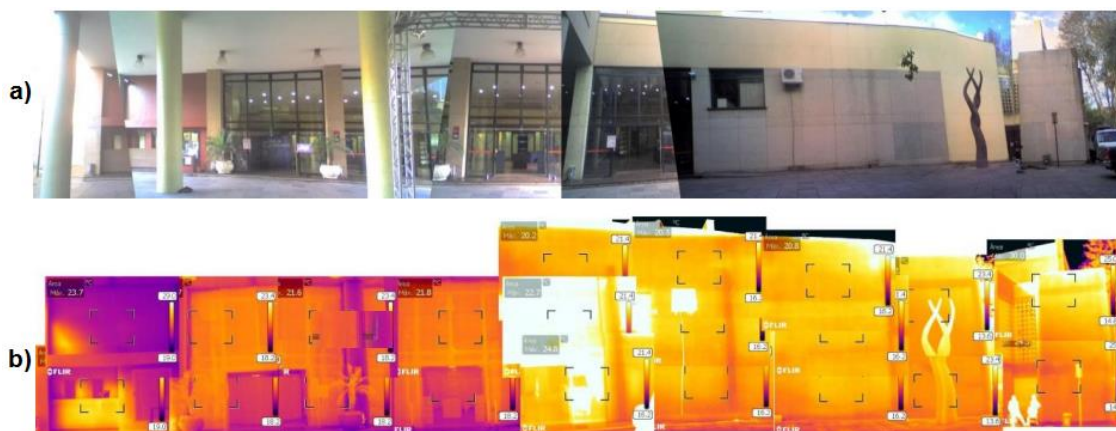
a) Levantamento visual da fachada noroeste. b) Levantamento termográfico da fachada noroeste.
